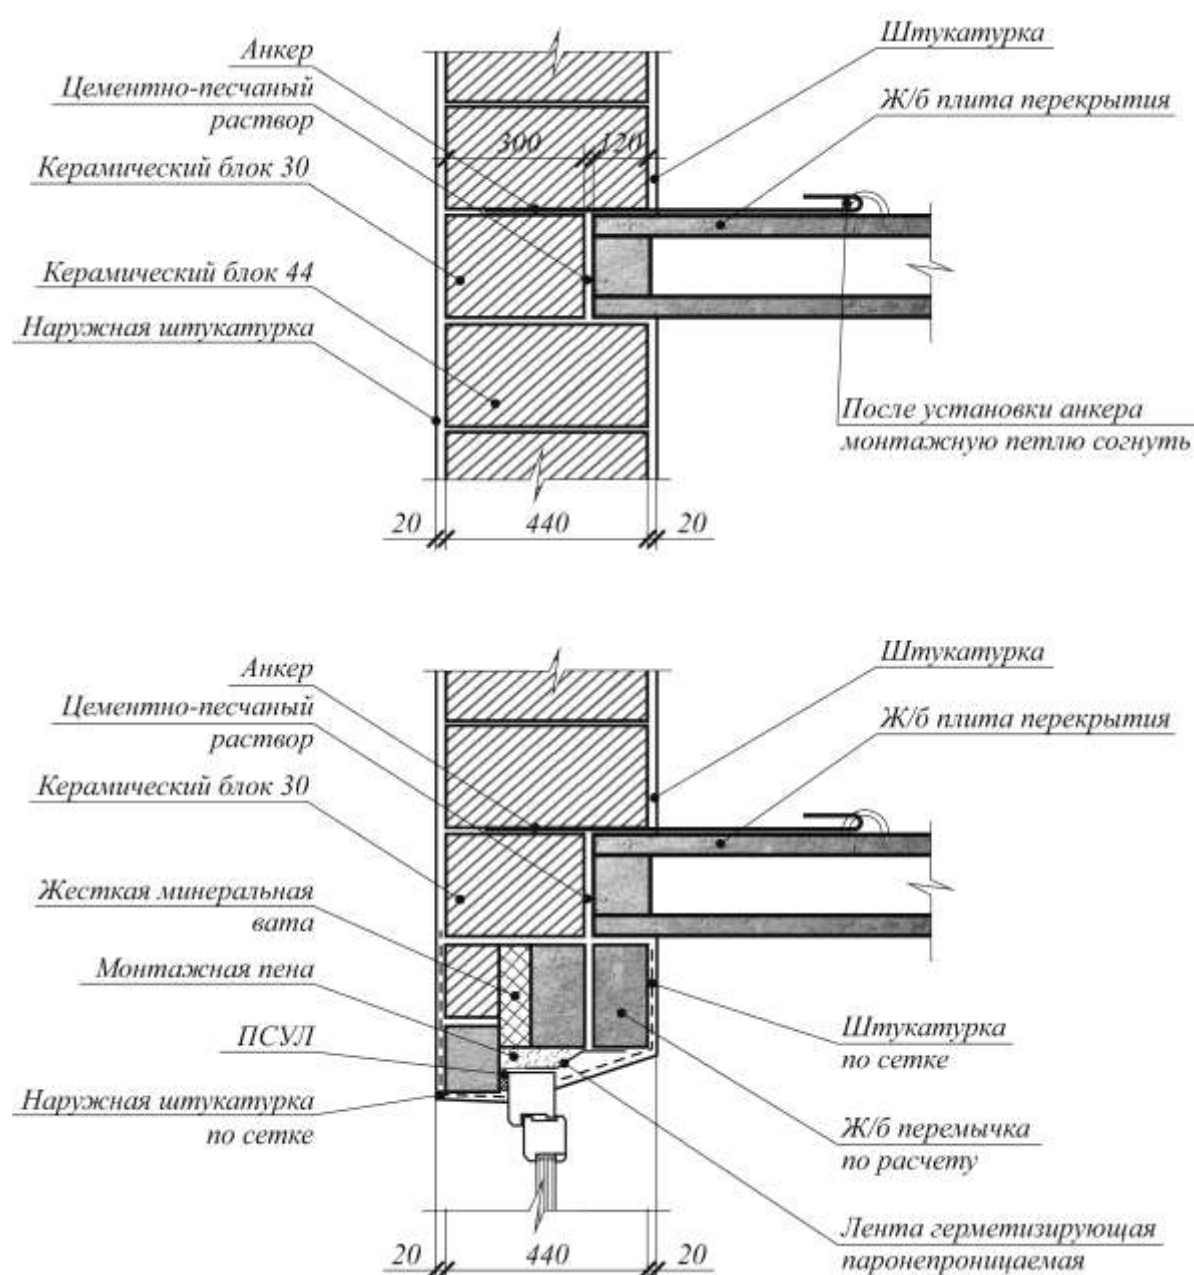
Узлы опирания железобетонной плиты перекрытия на однослойную стену из крупноформатного керамического блока
